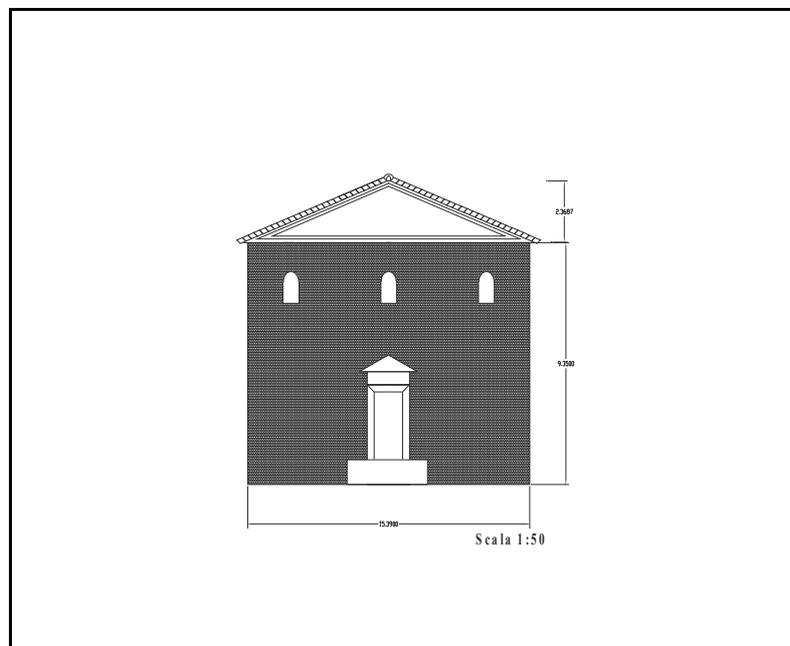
Prospetto ricostruttivo facciata ovest (secondo l'ipotesi A).
